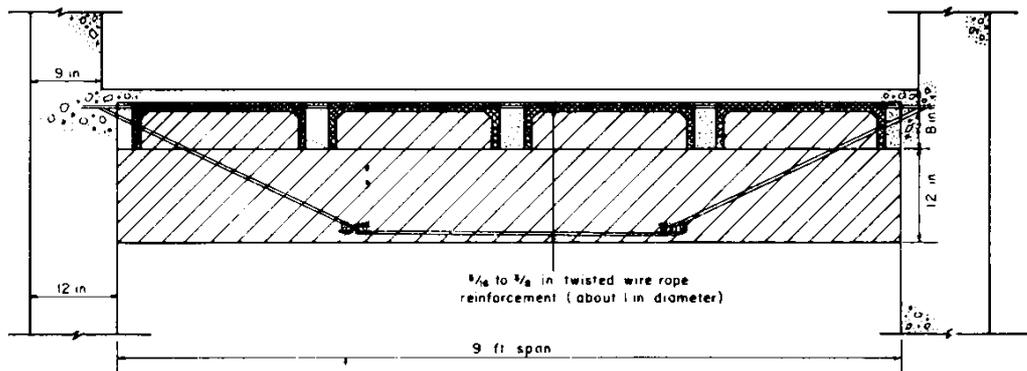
Desenho moderno do sistema de piso de Wilkinson executado 11 anos após a sua patente.
